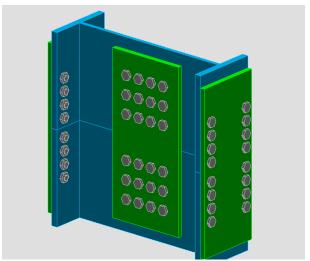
Assemblage poteau-poteau HEA800-HEA800
